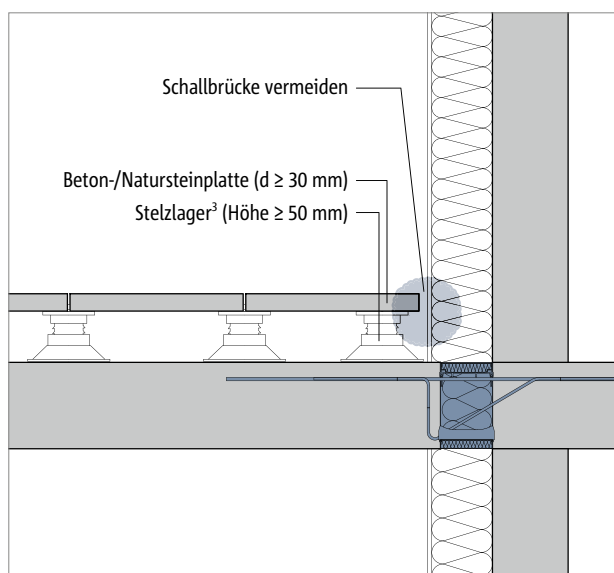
Balkonbelag mit Beton-/Natursteinplatten und Stelzlager
